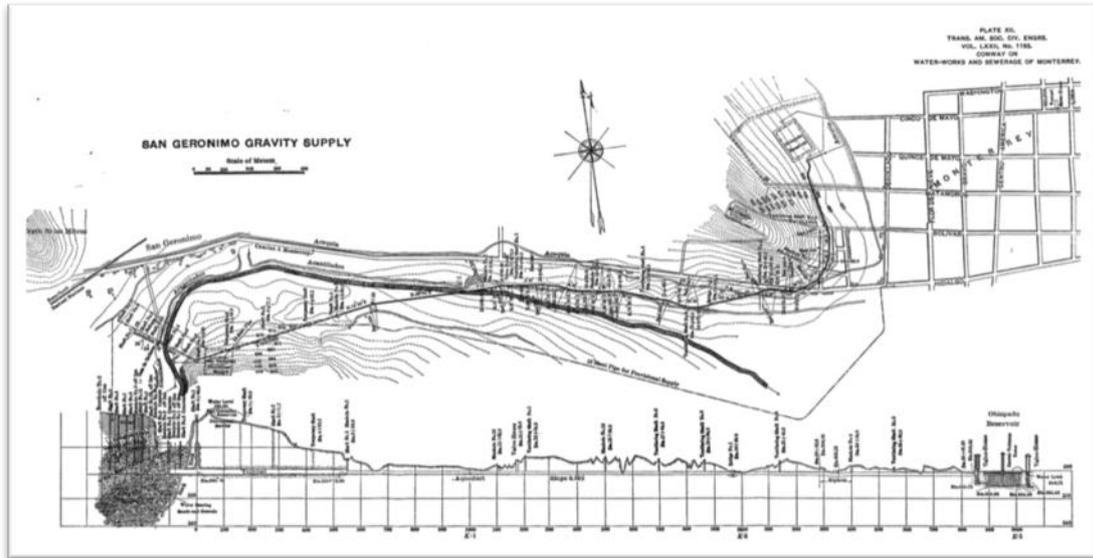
Plano de obras de la galería filtrante de San Jerónimo. (En: Graham, 1911).
